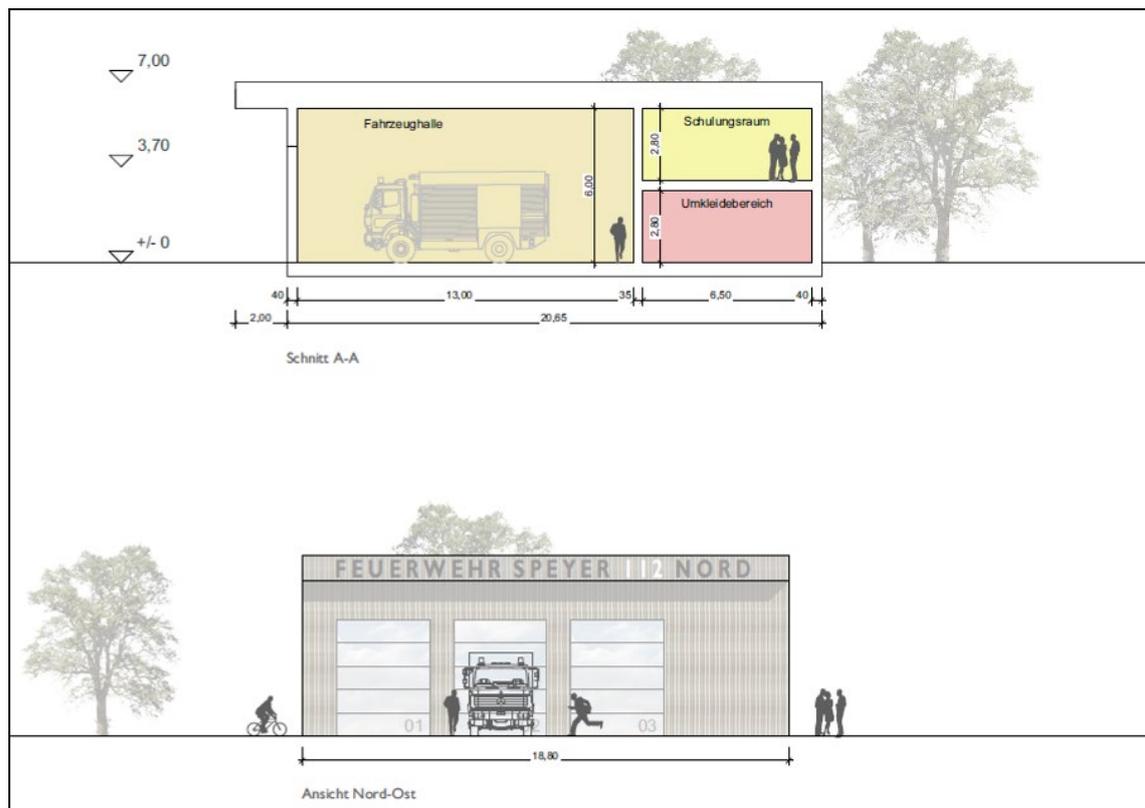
Mögliche Ansicht und Gebäudeschnitt, Quelle: Architekturbüro kplanAG Abensberg, Lageplan vom 03.03.2020
